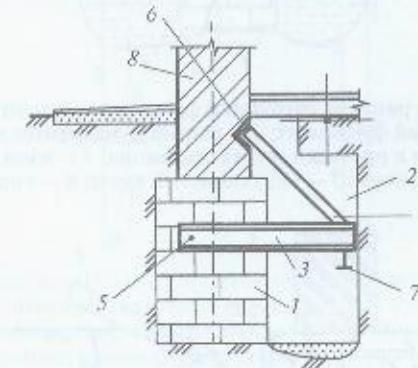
Уширение опорной площади ленточных фундаментов устройством одностороннего бетонного банкета:
